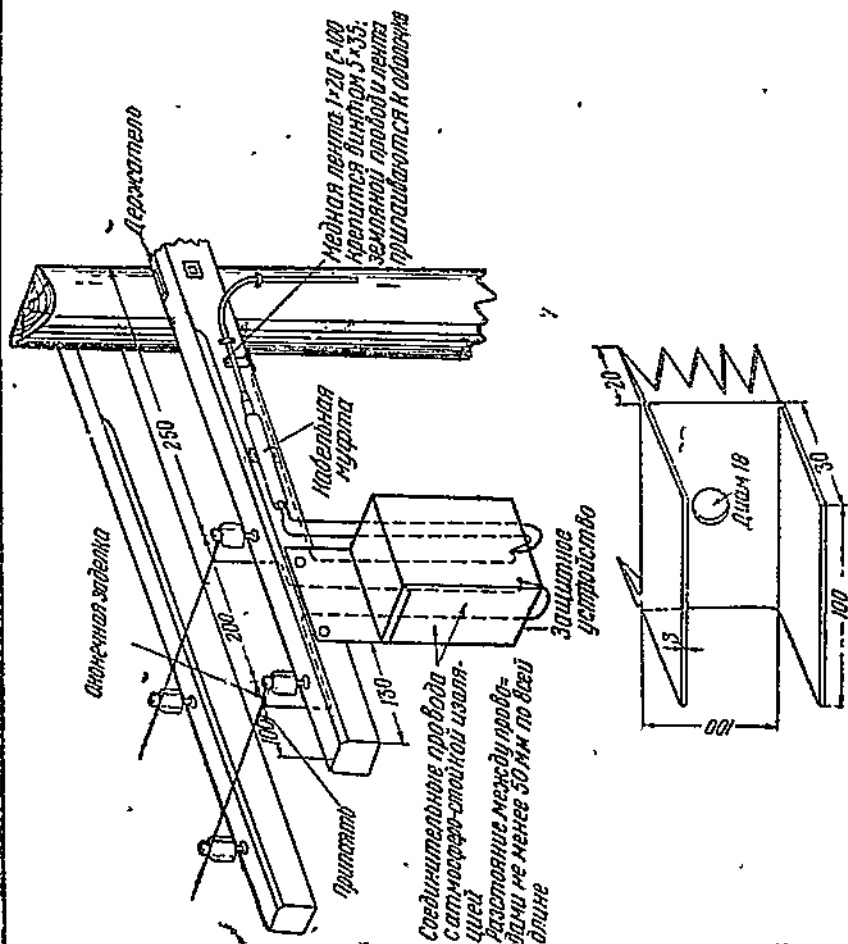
Размещение обогудования на в. (с установкой оконечной кабельной муфты).
